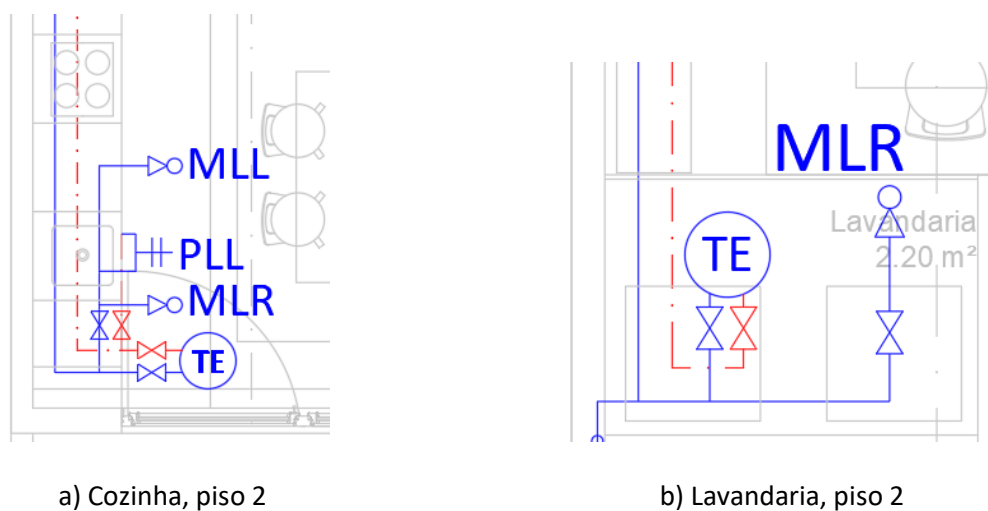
Traçado da rede de abastecimento em zona de ligação a dispositivos.
